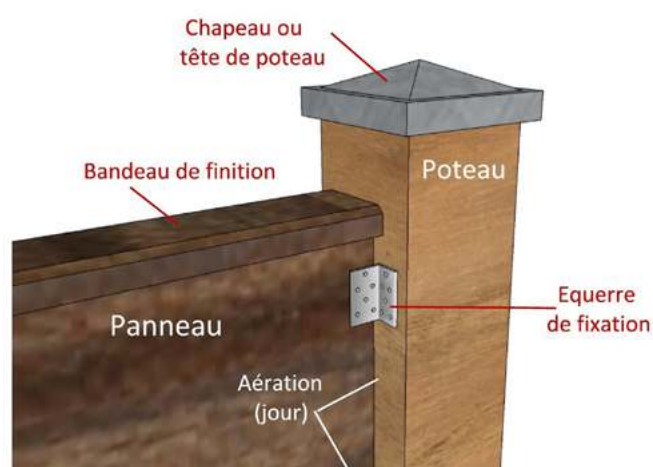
schéma de la liaison entre un panneau et un poteau (dessin de Cédric Houel).
